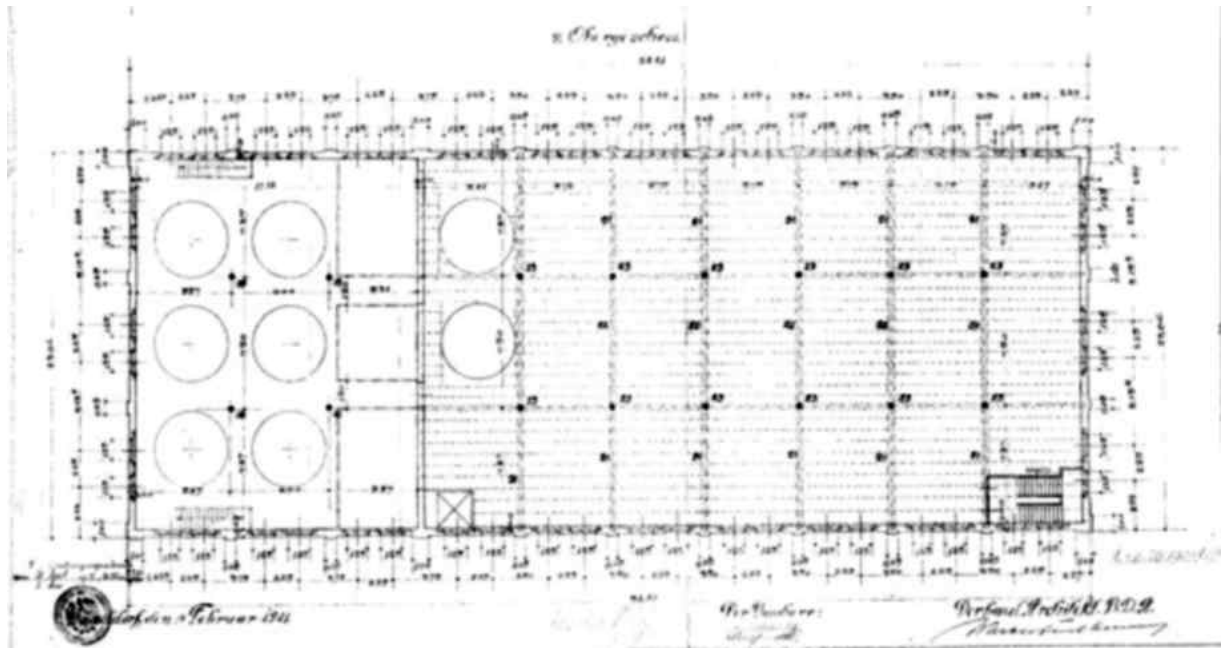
Neubau Seifenpulver-Fabrikgebäude Geb. C 02, 1911, 2. Obergeschoss - Architekt: Walter Furthmann
